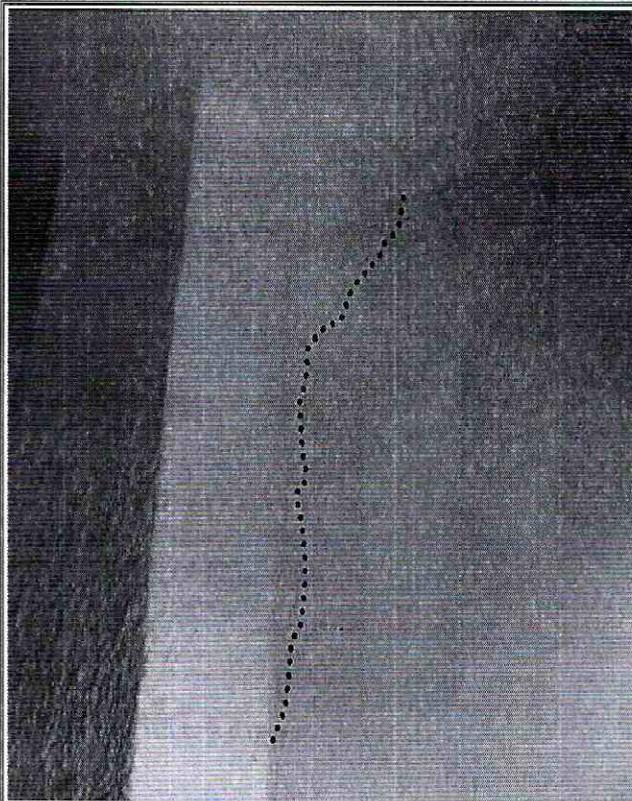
Fisuras muros divisorios edificación Sede A Sección Primaria
